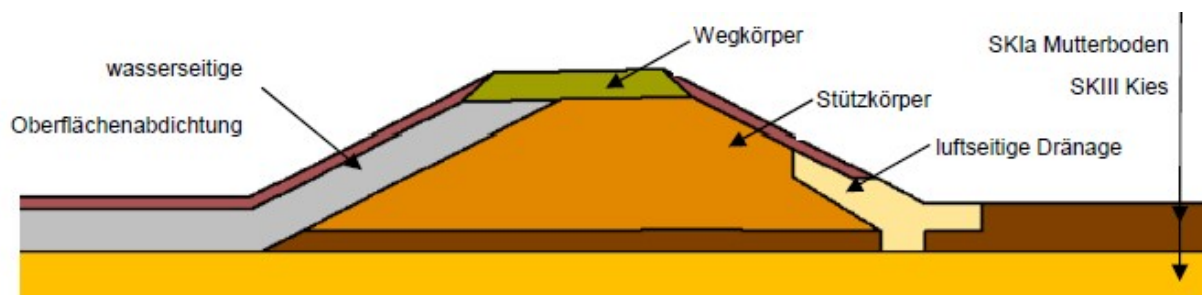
Schematischer Dammaufbau im Bereich der unterströmbaren Zulaufmulde (entnommen aus [13], Abb.8)
